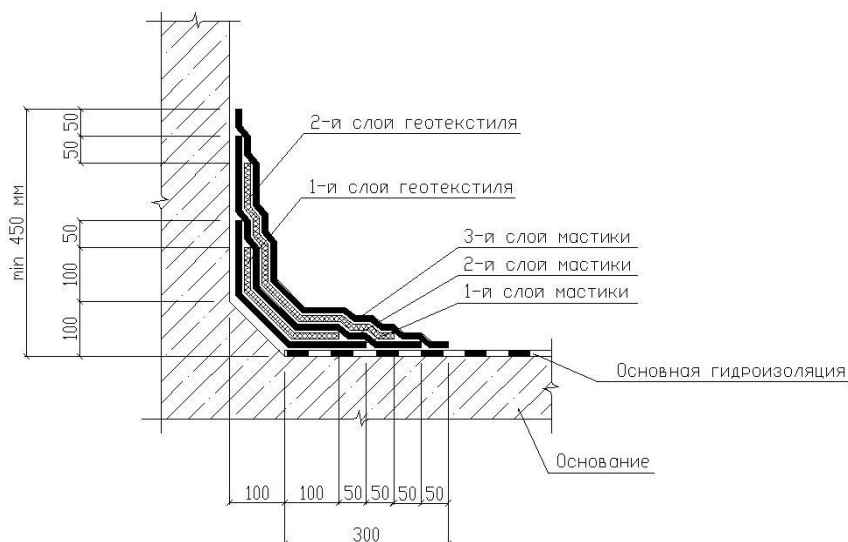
Устройство гидроизоляции примыкания к вертикальной поверхности. Вариант с дополнительным усилением.
